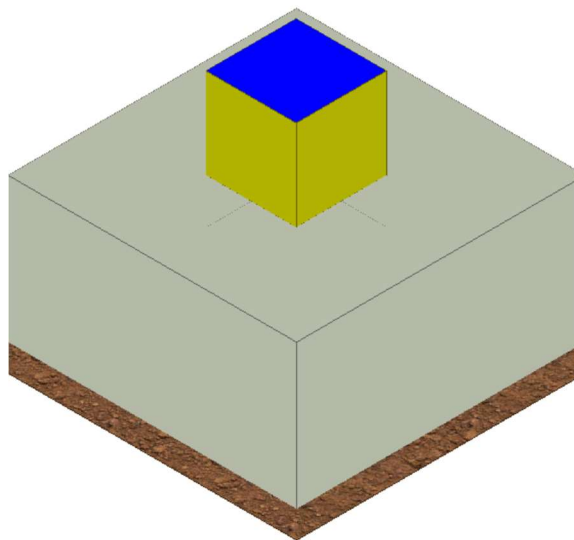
vista tridimensionale della fondazione del TRASFORMATORE DI TENSIONE INDUTTIVO
